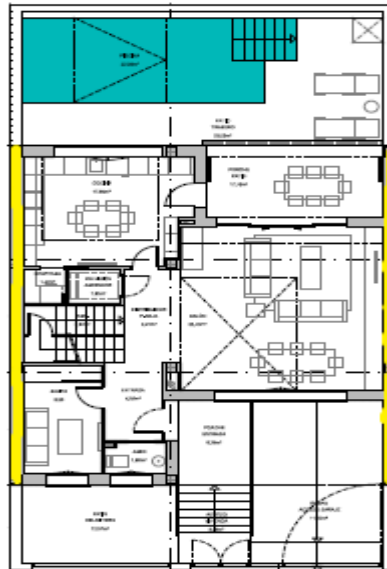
Medianeras en el plano de la planta baja de la vivienda
